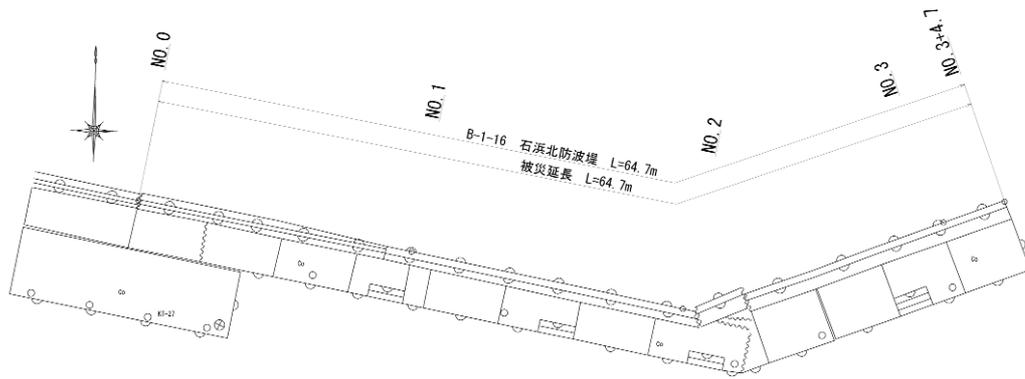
塩釜港区\_石浜北防波堤の平面図（被災後）
